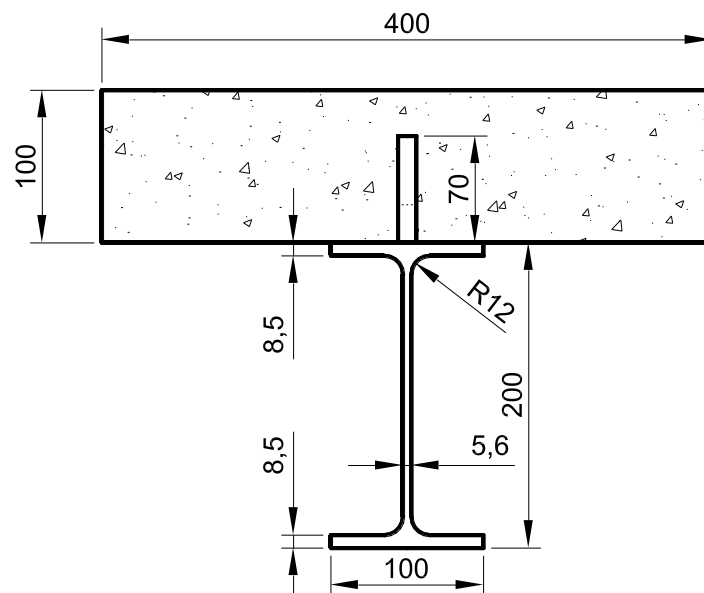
Geometria da seção transversal da viga mista (dimensões em mm).
